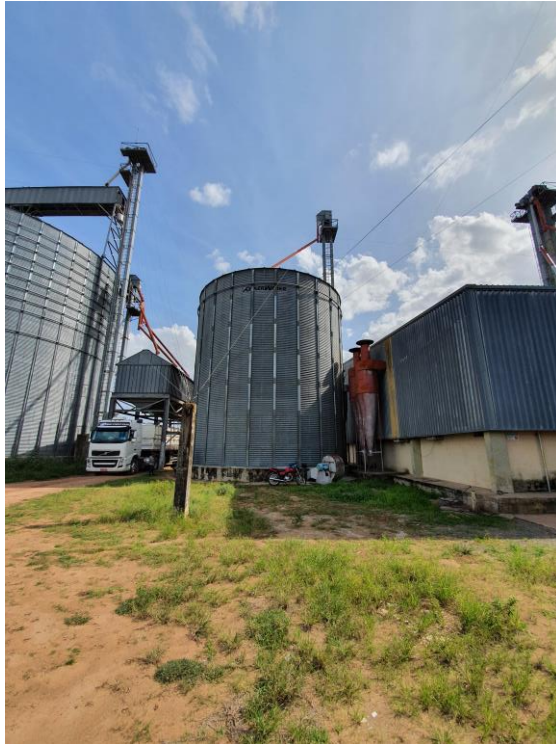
Vista dos Silos de Armazenamento e 04 Bases Para novos Silos
